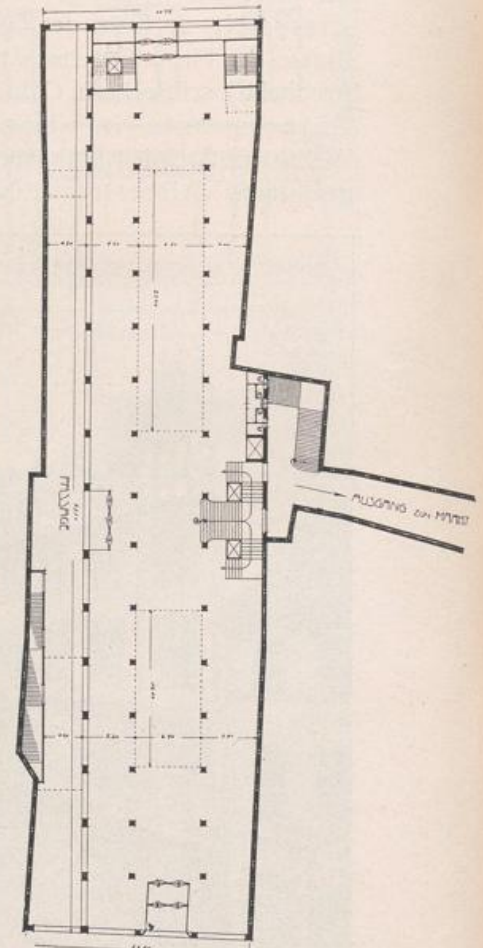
Bolkerstr. 19/21. Passagenbau. 1:400.
